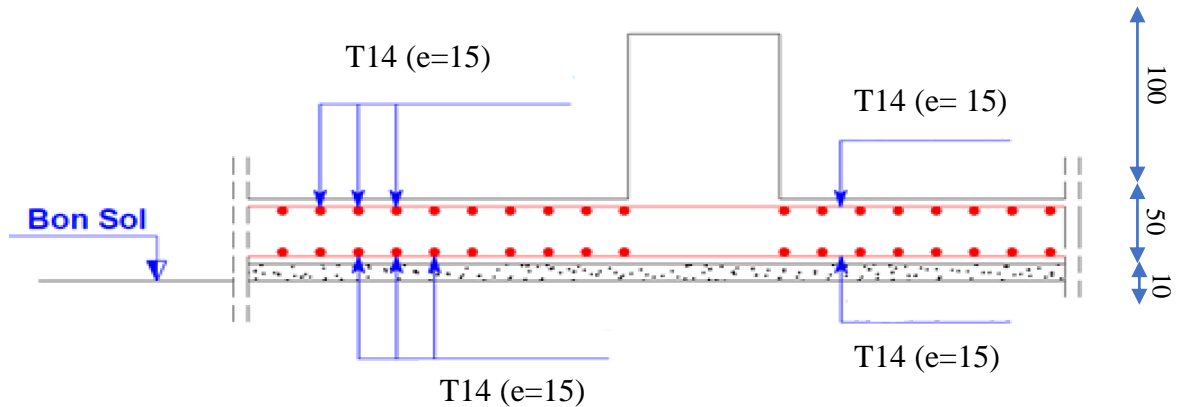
Schéma du ferrailage de la dalle.
